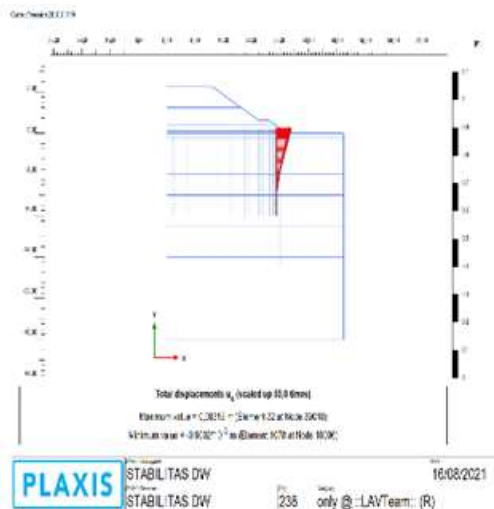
Stabilitas global lereng di area sta. 9+700 BH – 02 dengan menggunakan perkuatan *diaphragm wall* dan *mini pile
